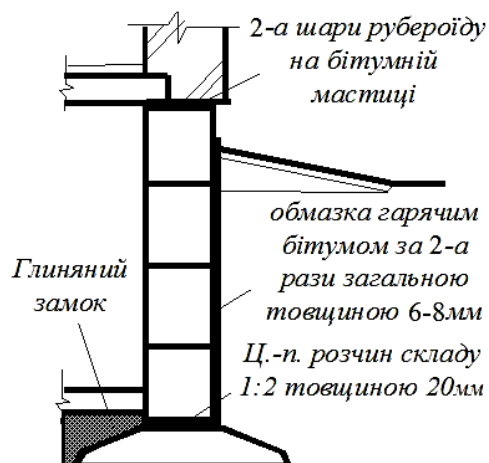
Капілярна гідроізоляція фундаменту
